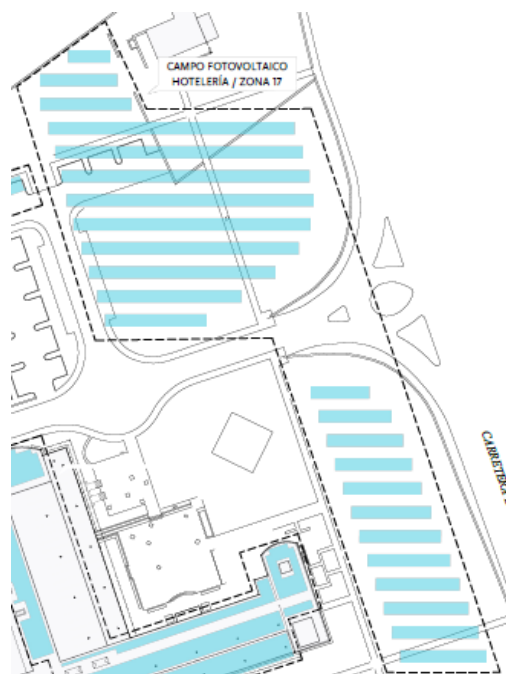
Disposición de las placas fotovoltaicas en el campo de Hotelería
